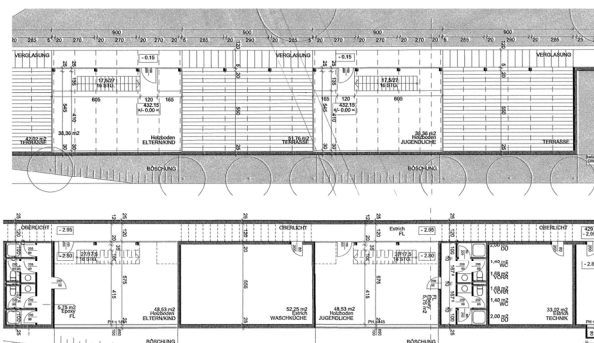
Geplanter Gemeinschaftsbauteil mit zweigeteilten, zweigeschossigen Bereiche samt Sanitär, Waschküche und pergolenüberdachten Terrassen. Grundriss Erdgeschoss und Untergeschoss. (Quelle: Ursula Spannberger)
